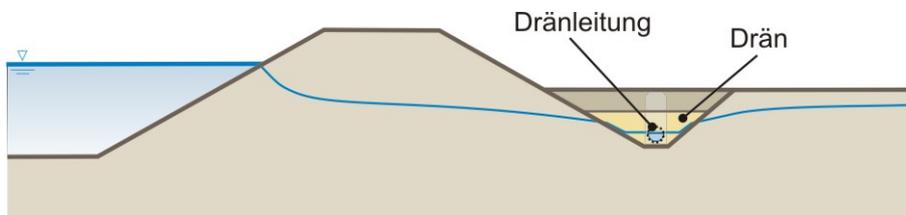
Auflastdrän am Dammfuß mit Dränleitung
